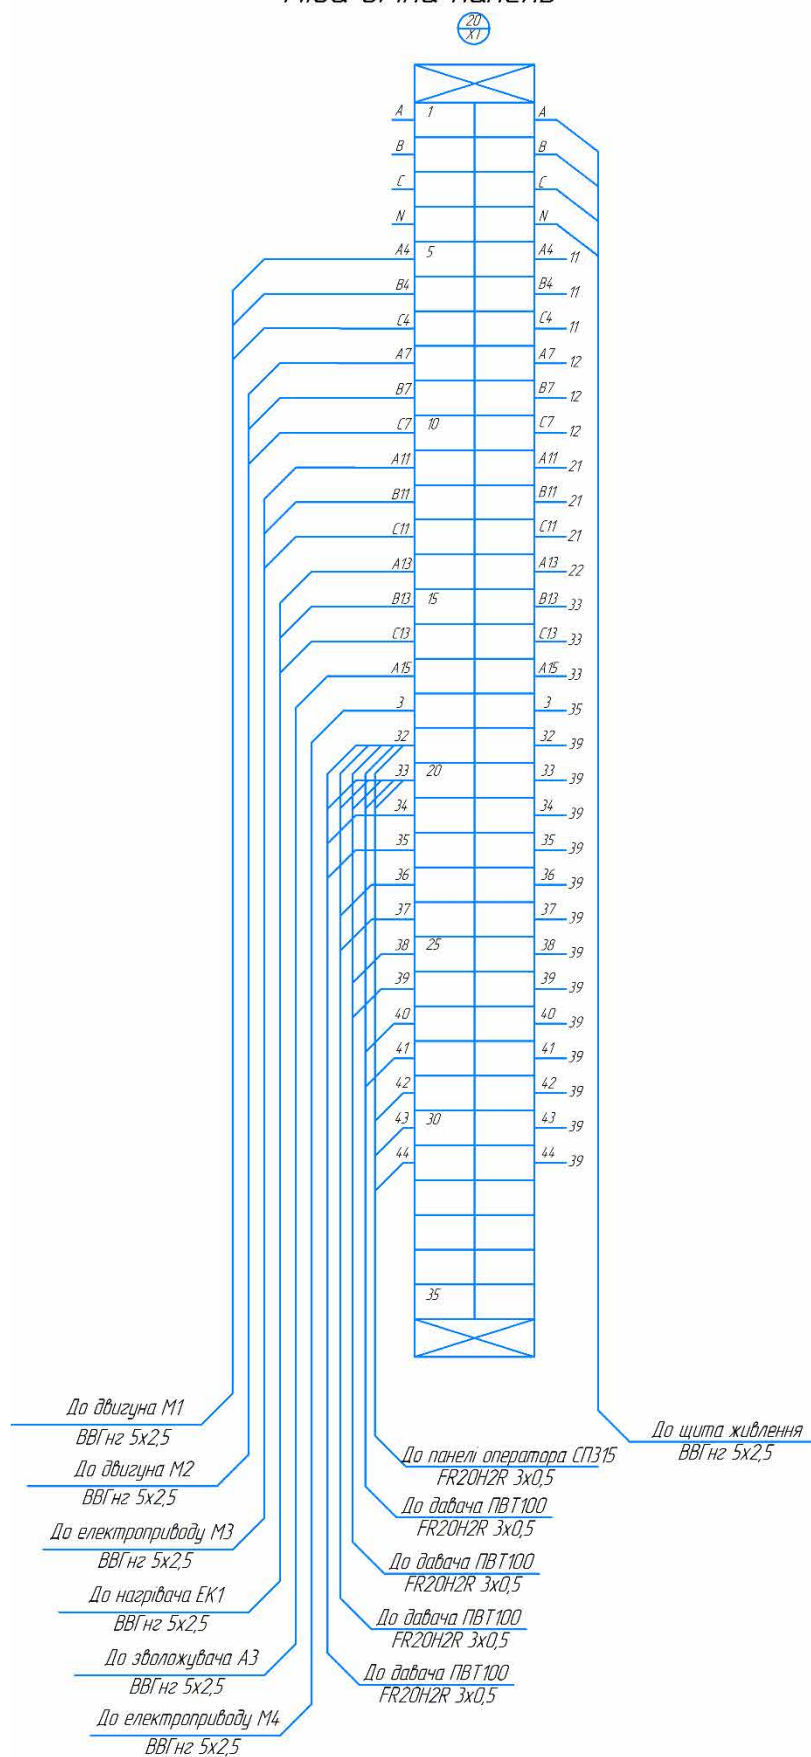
Фрагмент лівої бічної панелі щита схеми з'єднань
